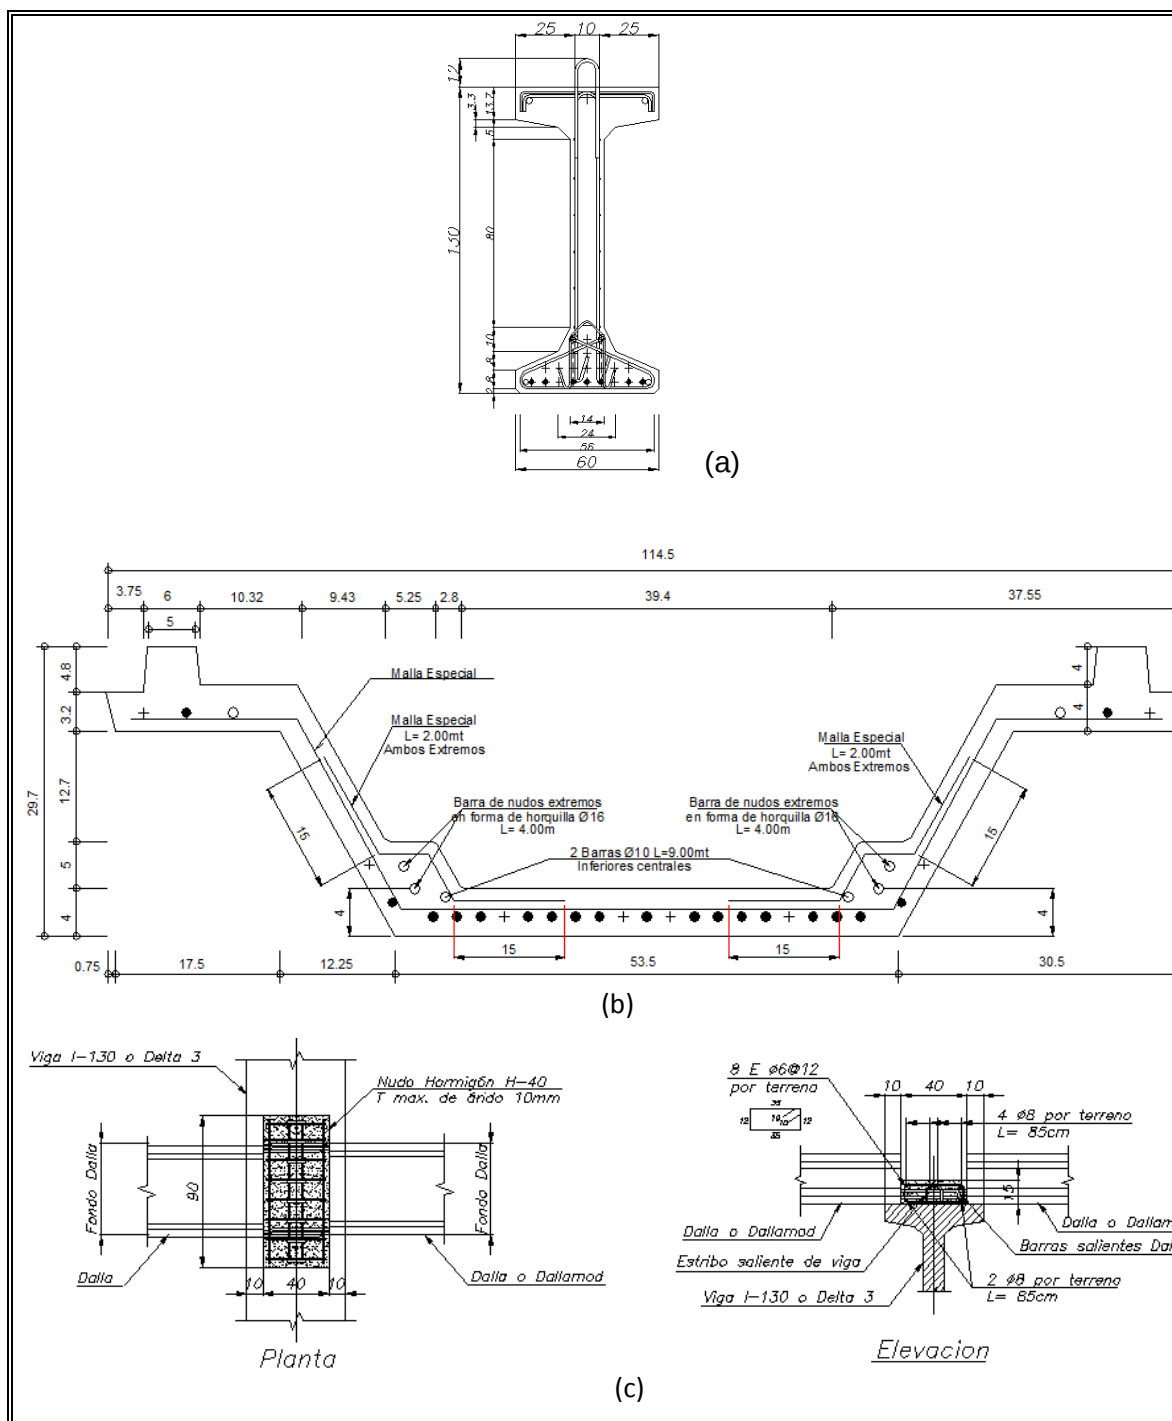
Sección transversal vigas I-130 (a), canalón Dalla (b) y detalle del nudo hormigonado en terreno Dalla-Viga I-130 (c). Tomado de planos de Preansa S.A. Dimensiones en centímetros.
